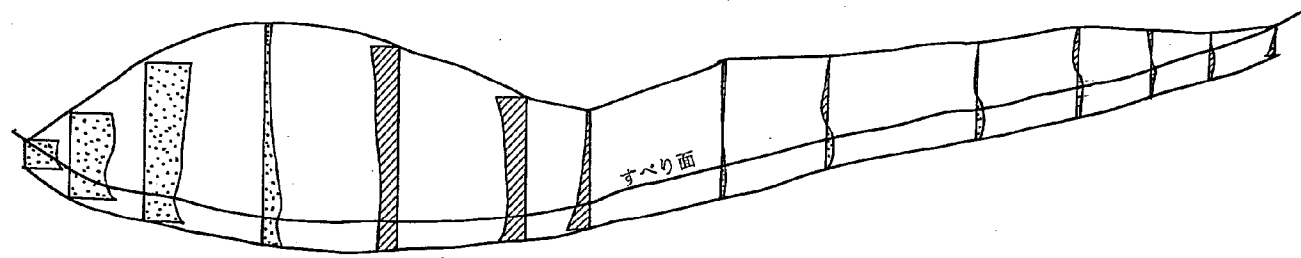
49-1-1 断面せん断力 T(X, Y) 分布図
